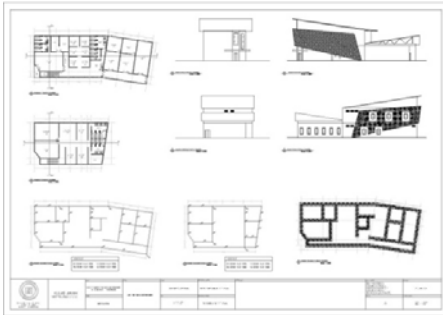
Denah Lantai Dasar & Tampak Krematorium
